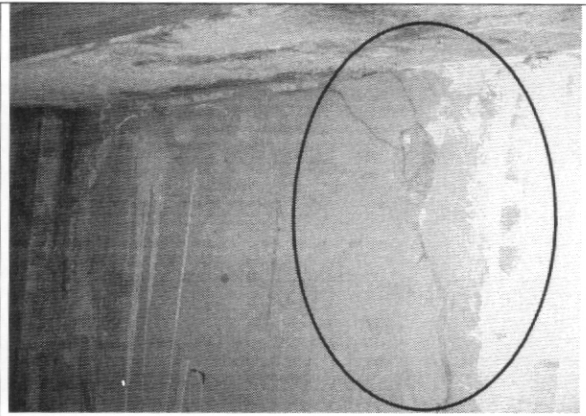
Grietas en muro costado occidental, local extremo sur
